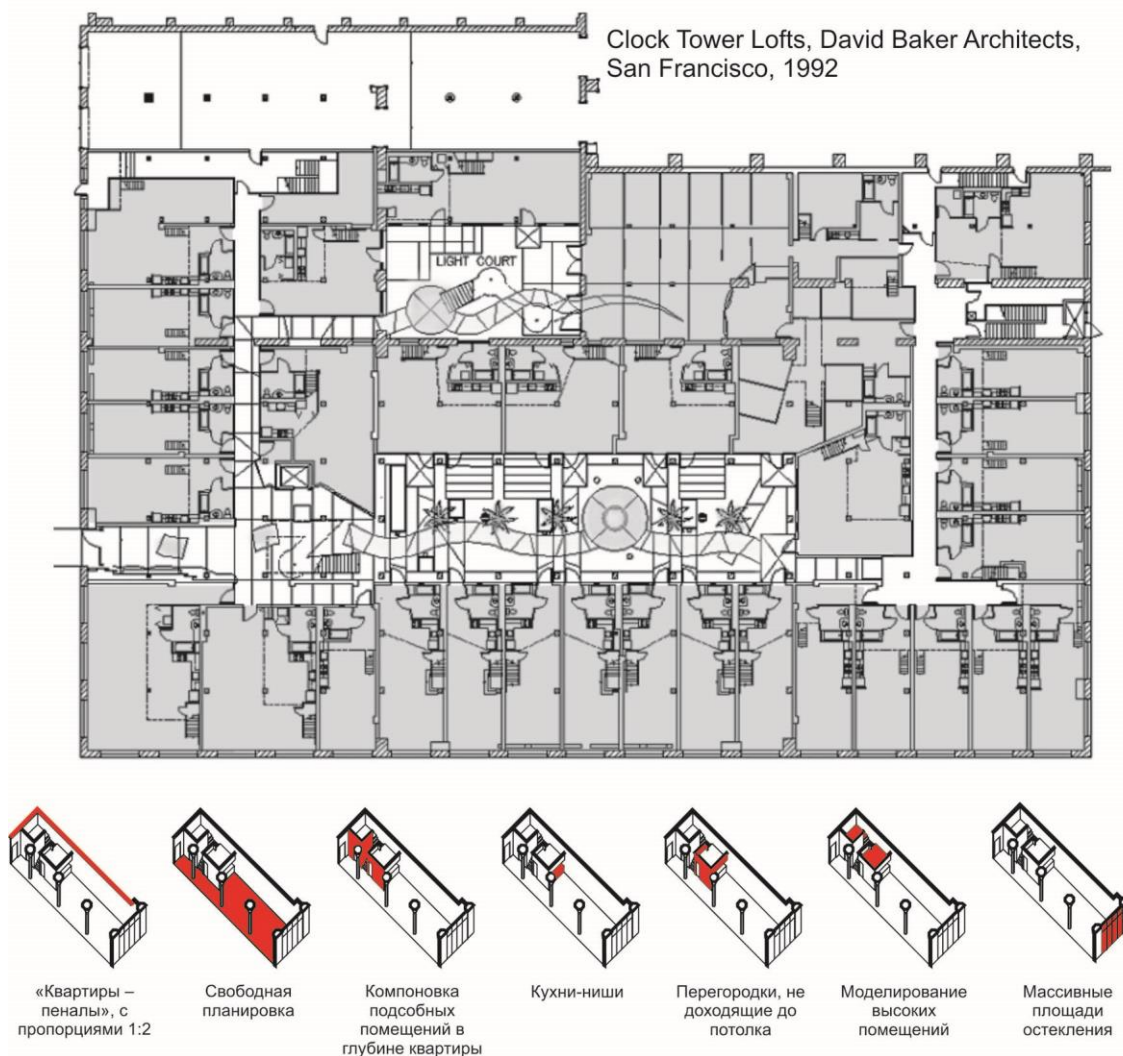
Схемы планировки «квартир-пеналов», на примере проекта Clock Tower Loft, арх. David Baker Architects (Сан-Франциско, США, 1992)
